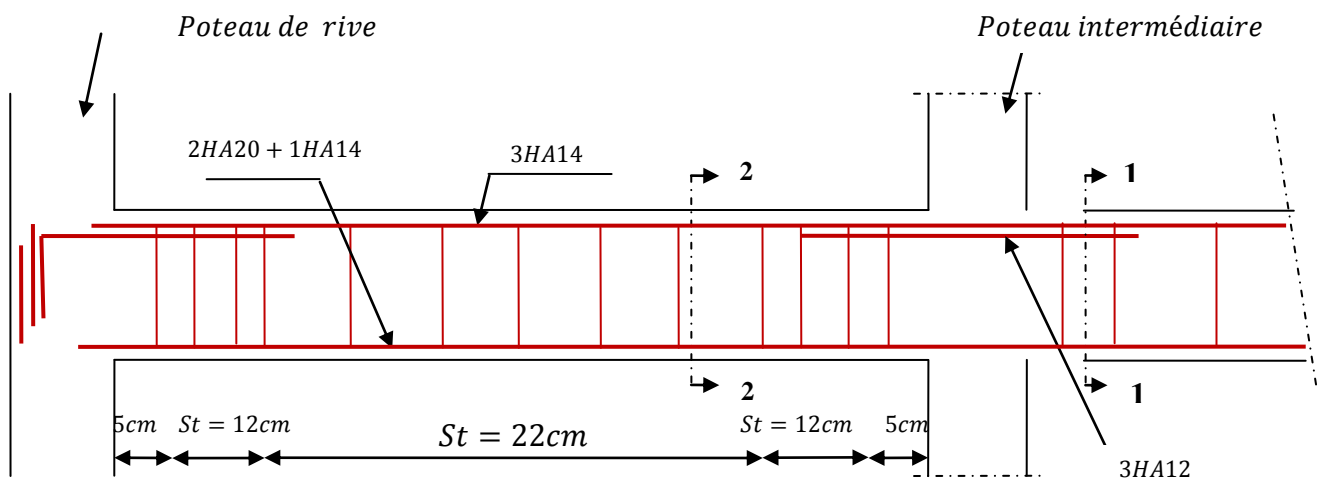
Schéma de ferrailage des poutres principales (3^{ème} au 12^{ème} étage)
